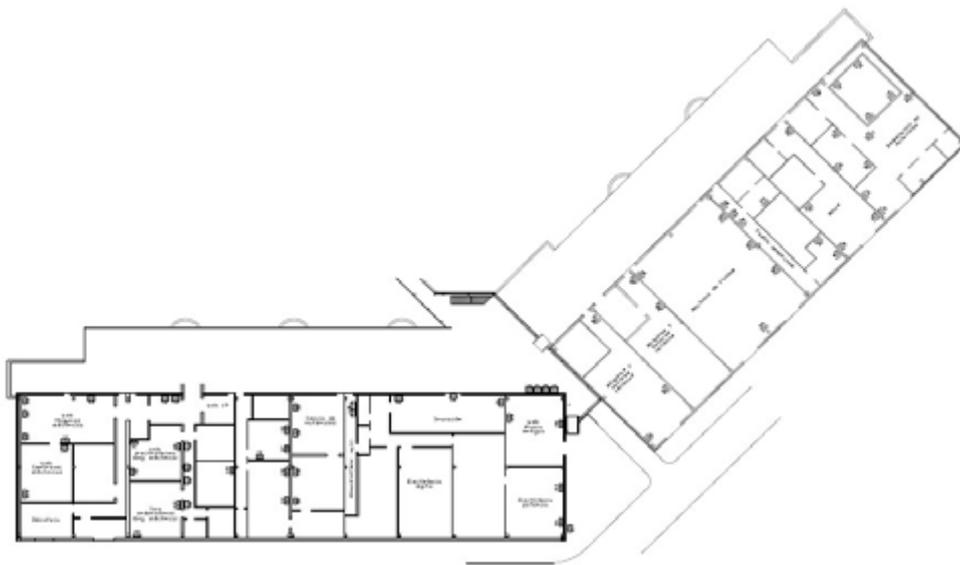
Vista en planta de los espacios en la sede campus de la EEI (Edificio II – Zona IV)
